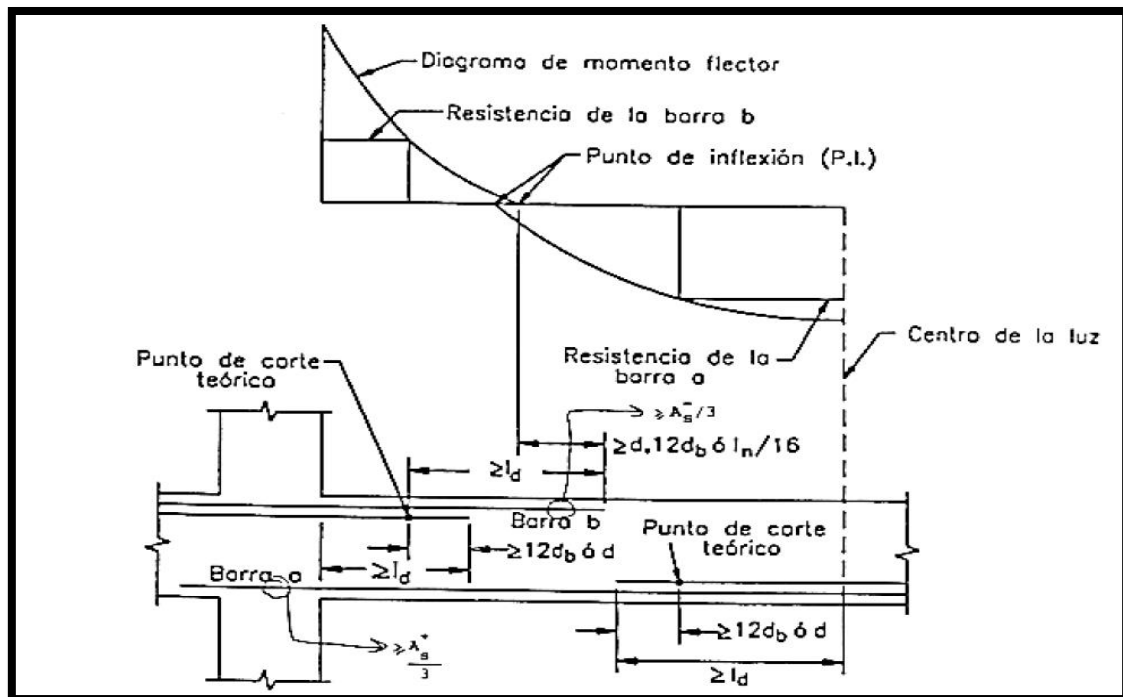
Cortado del refuerzo longitudinal en elementos sometidos a flexión.
